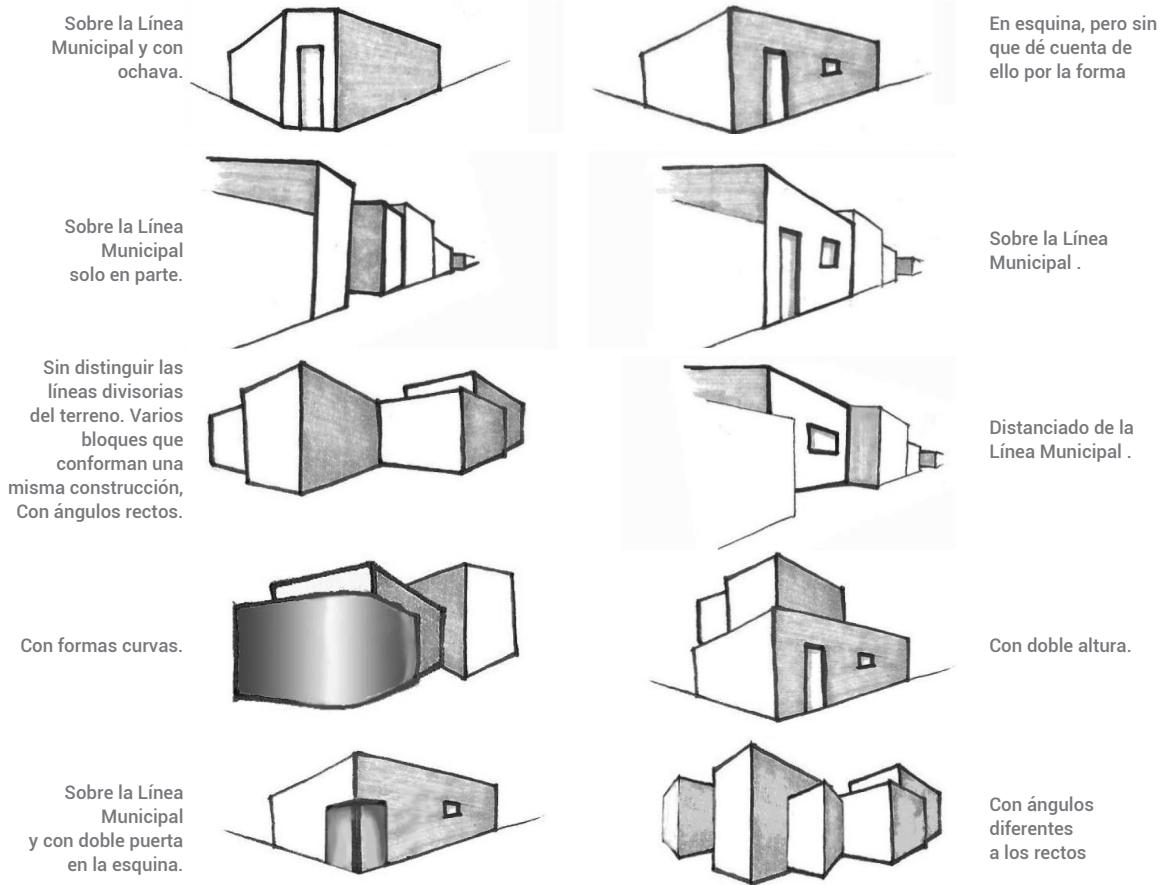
Formas arquitectónicas identificadas dentro del Conglomerado Urbano de Purmamarca. Fuente: TOMMEI, 2016
